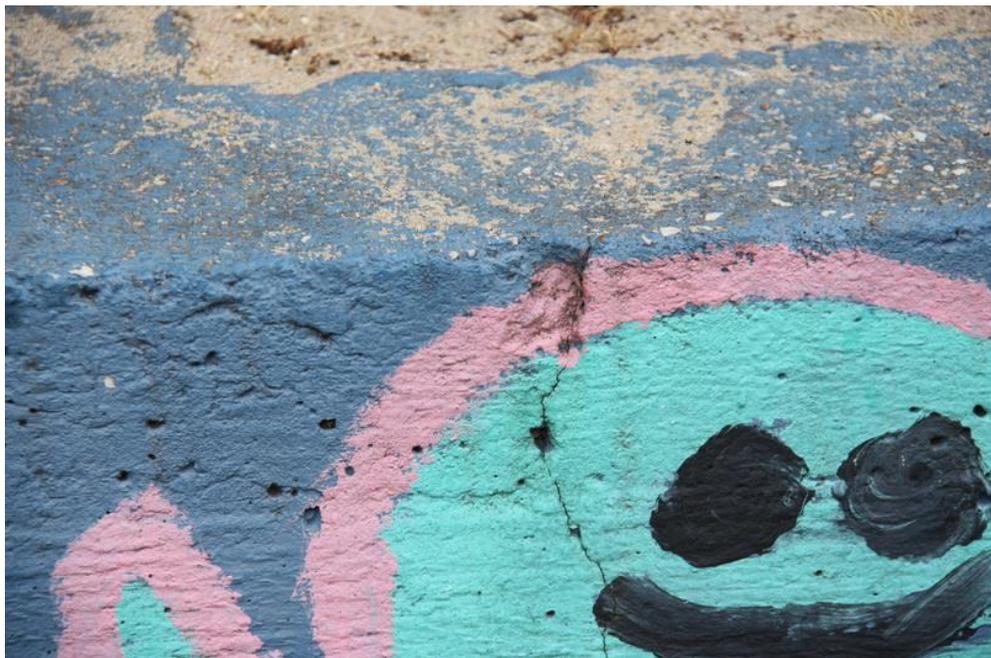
Detailansicht der Hochbeeteinfassung von Baum-Nr. 54 mit Rissbildung in der Betonmauer. Die Risse sind mit hoher Wahrscheinlichkeit durch den Wurzeldruck (Horizontalkraft) des Baumes entstanden.
